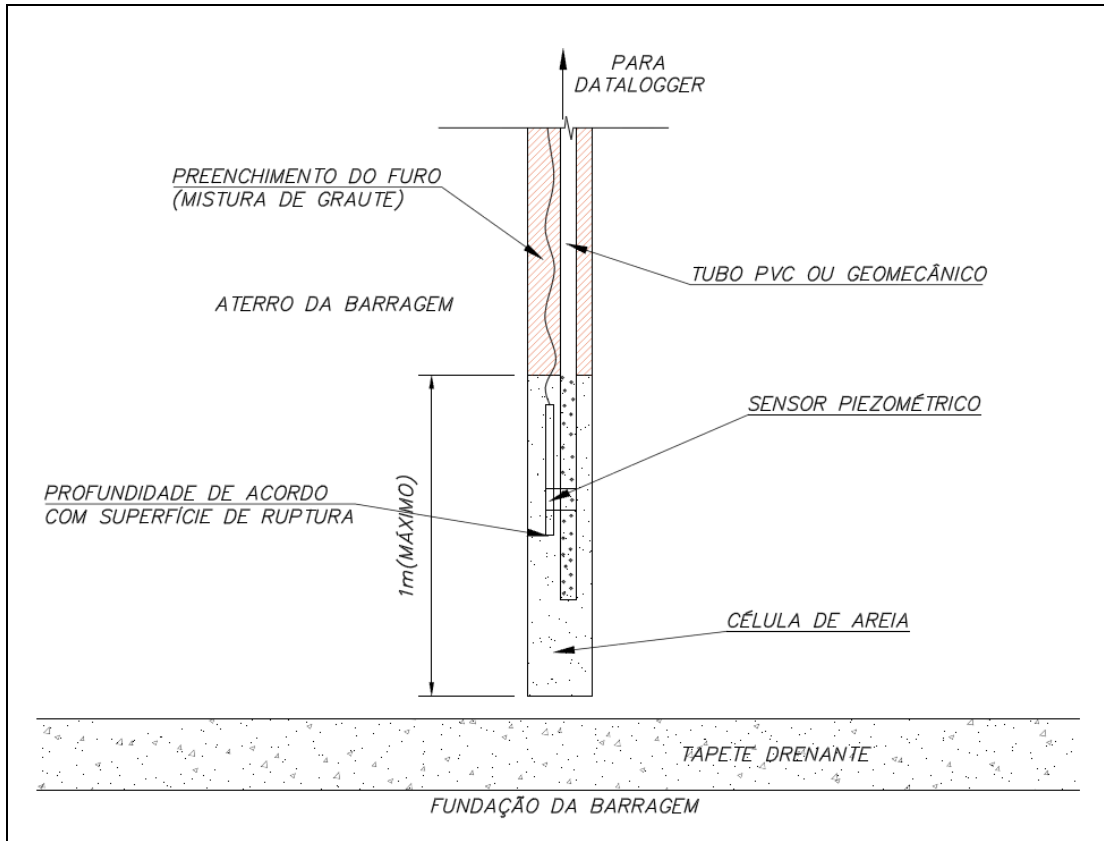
Perfil construtivo típico de um INA ou piezômetro Casagrande instalado em maciço de barragem de terra.
